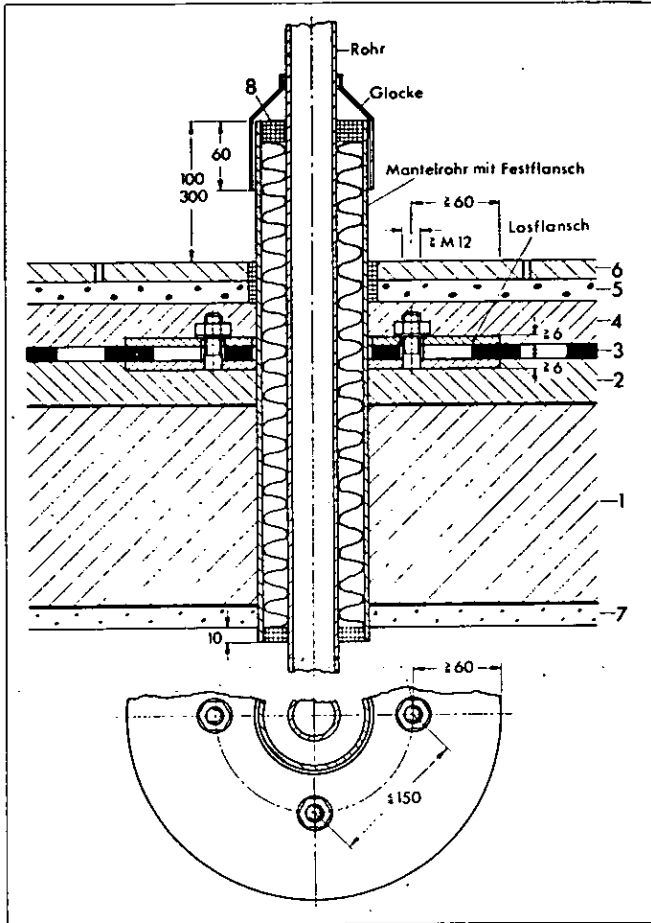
Rohrdurchführung einer isolierten Rohrleitung mit Anschluß an die Abdichtung nach DIN 4122; Flanschdicke ≥ 6 mm, Flanschbreite ≥ 60 mm, Schraubendicke $\geq M 12$, Schraubenabstand ≤ 150 mm [6].
